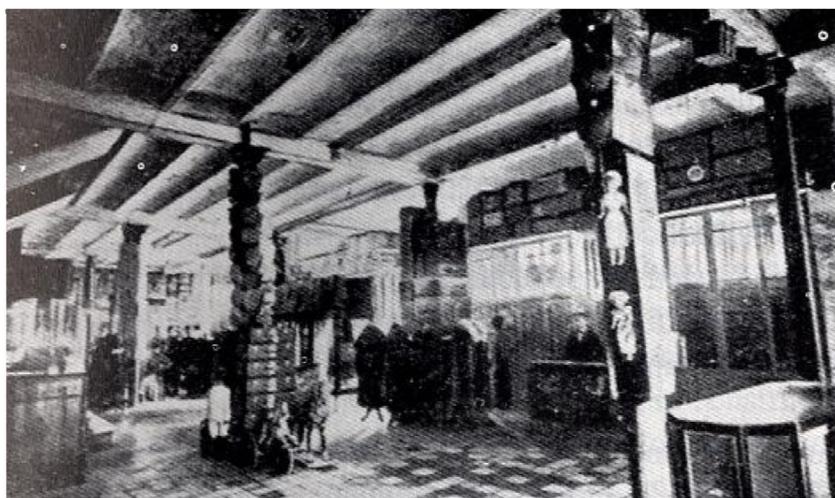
Techo de bovedillas tabicadas en el edificio 'La Reconquista' (1916)
